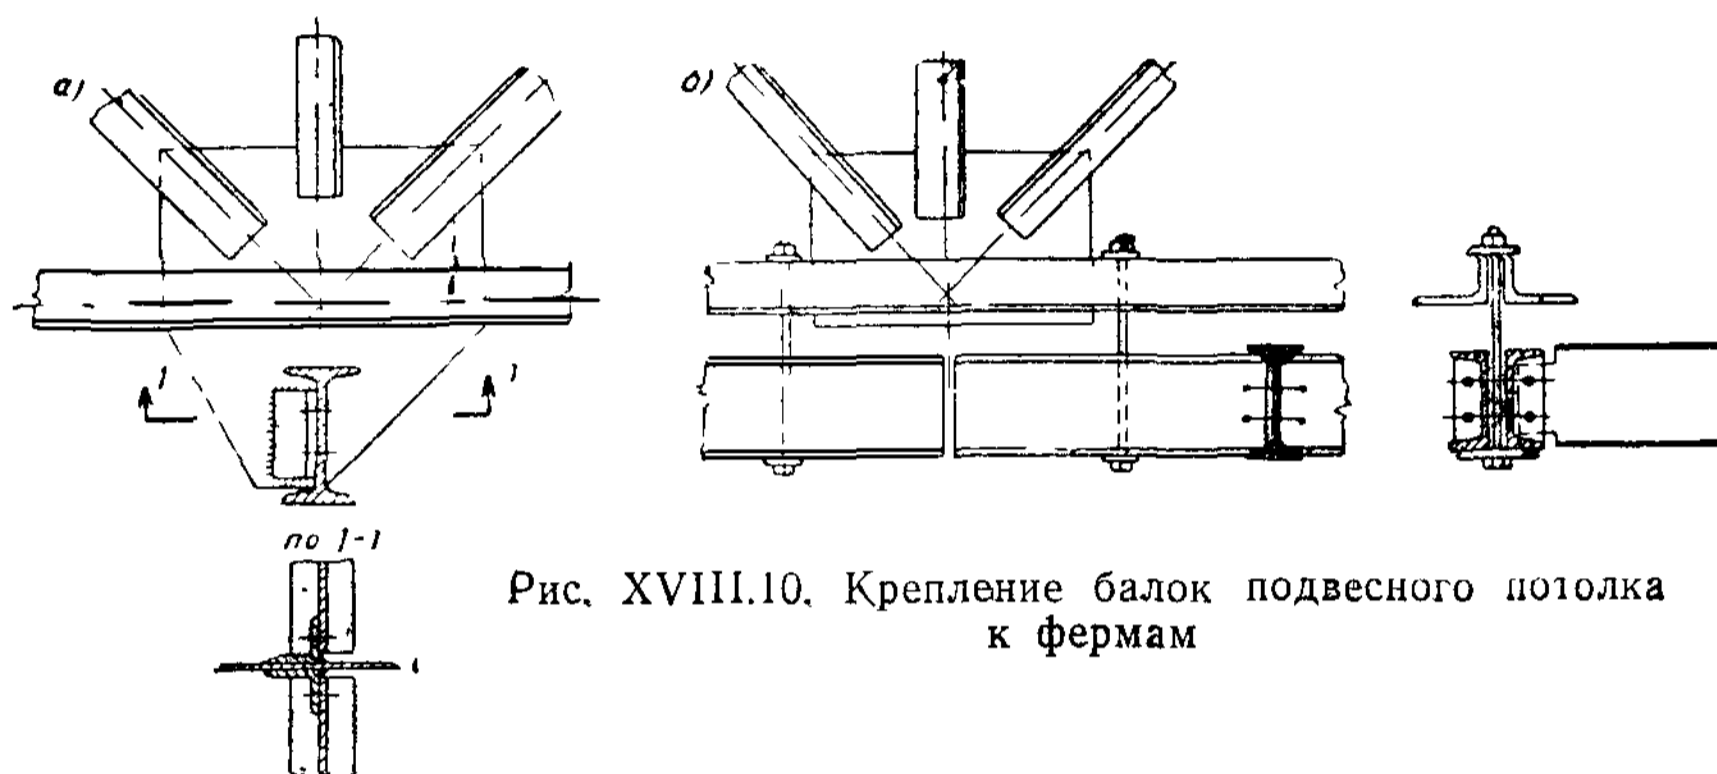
Крепление балок подвесного потолка к фермам
